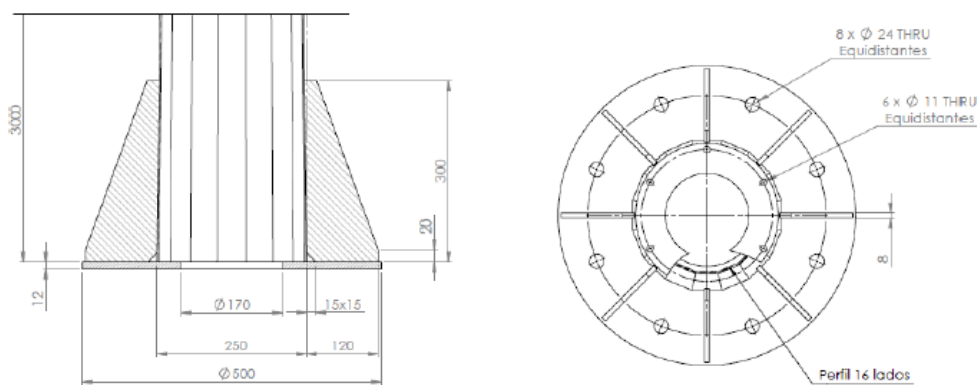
Pormenor tipo, corte e planta da ligação da base da coluna de suporte da turbina Omniflow
